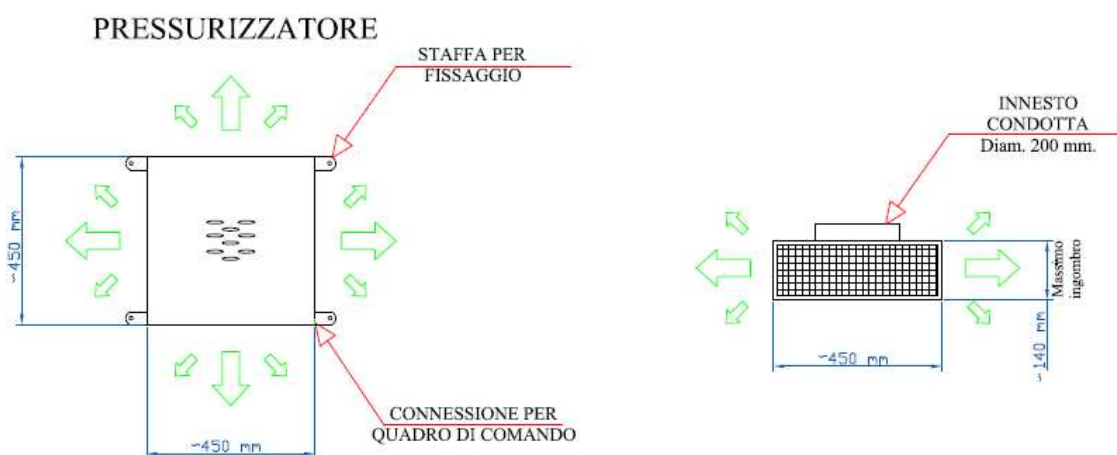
Pressurizzatore - Schematizzazione dell'espulsione dell'aria
